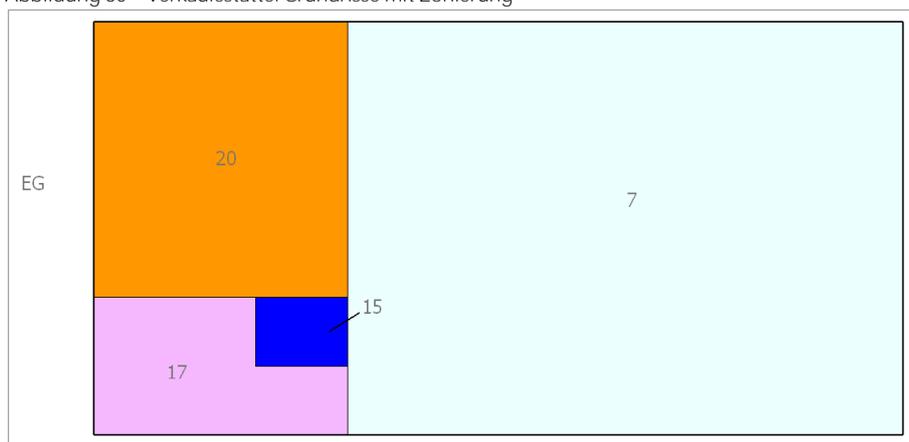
Verkaufsstätte: Grundrisse mit Zonierung
